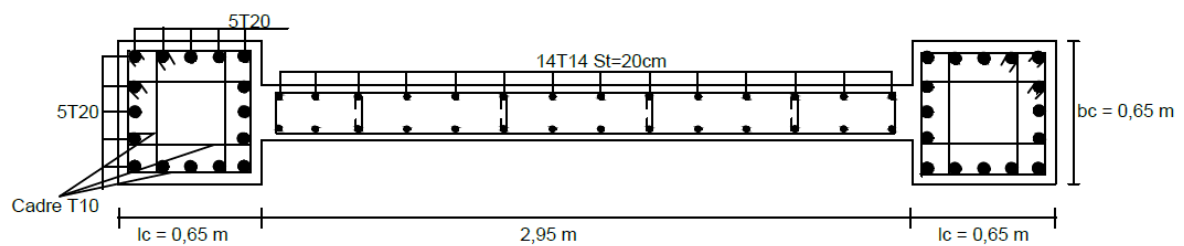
La coupe de ferraillage des voiles 1 et 2.
